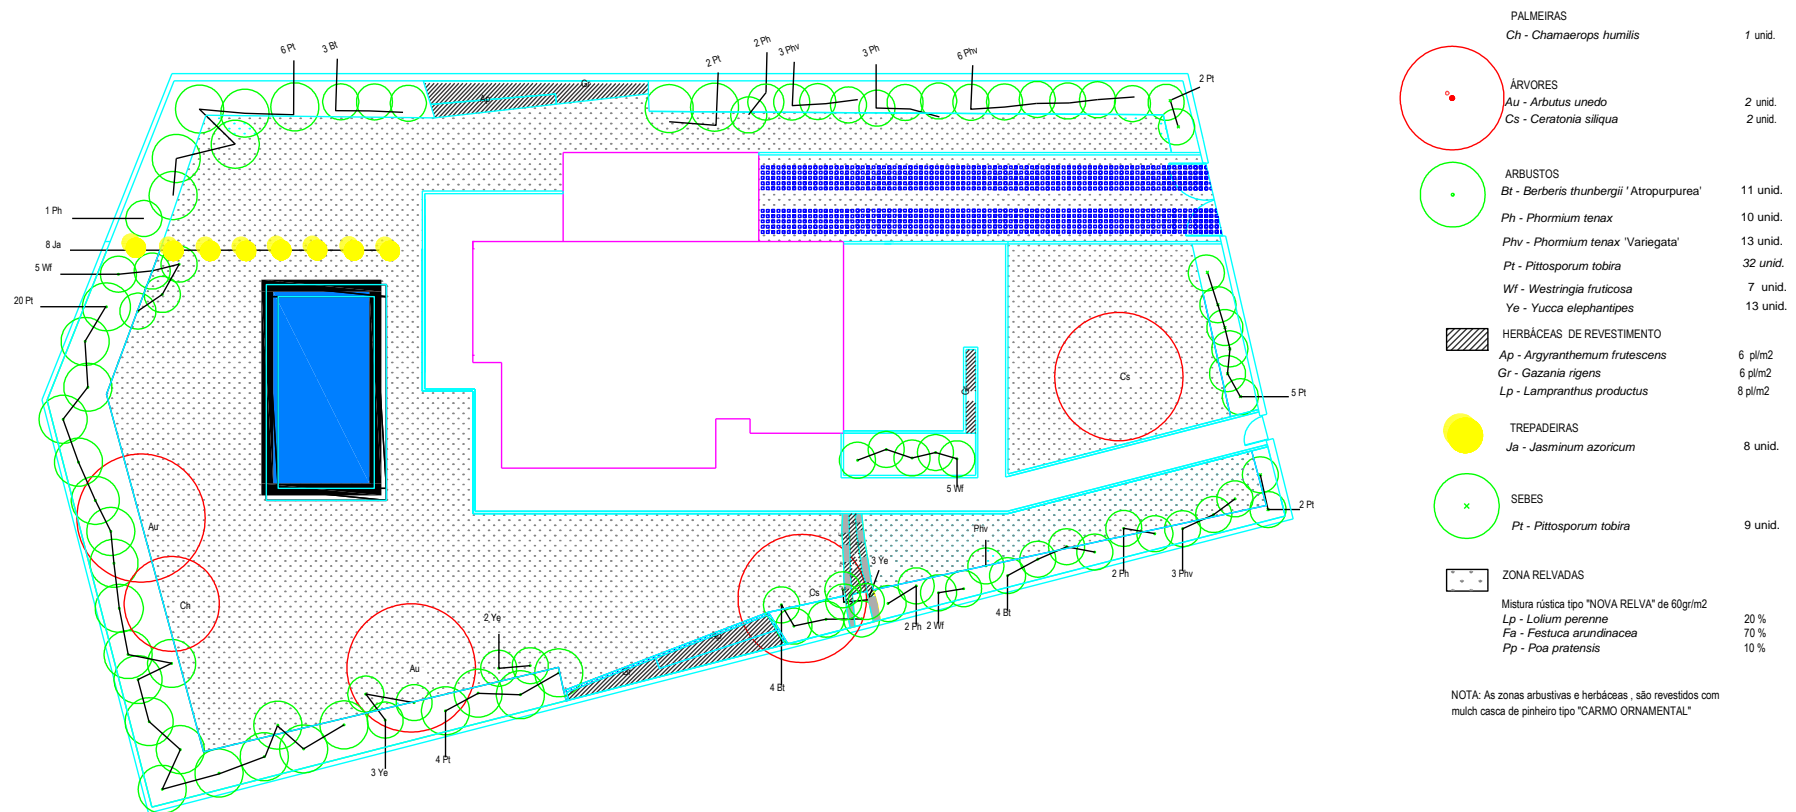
Plano de plantação referente à situação B - Beja.
